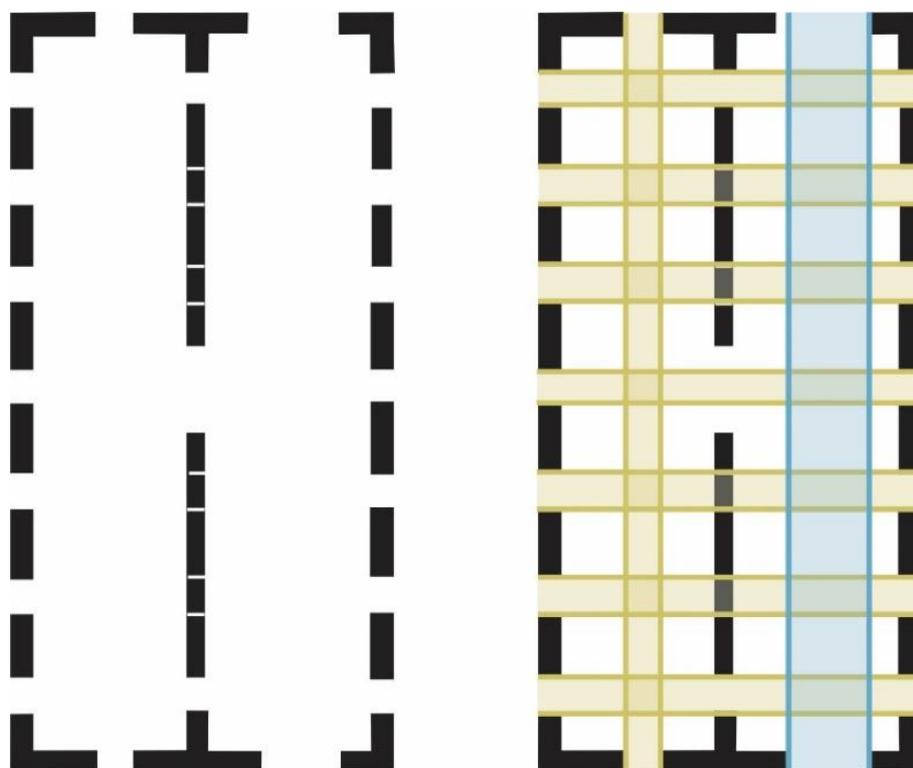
Planta baixa do 2º pavimento do Bloco II do PSC atual. Em amarelo são as simetrias entre as sacadas e, em azul, das portas.
